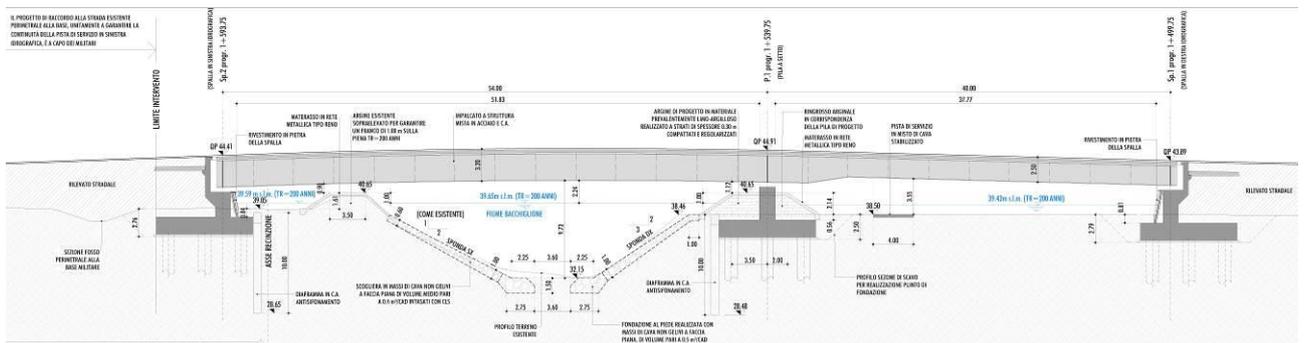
SEZIONE LONGITUDINALE PONTE SUL FIUME BACCHIGLIONE
